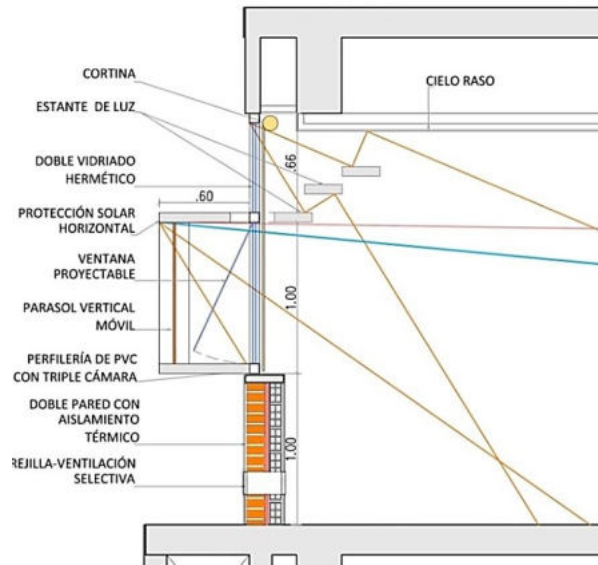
Detalle de carpintería, parasol horizontal y estante de luz (Fachada Oeste) Corte
